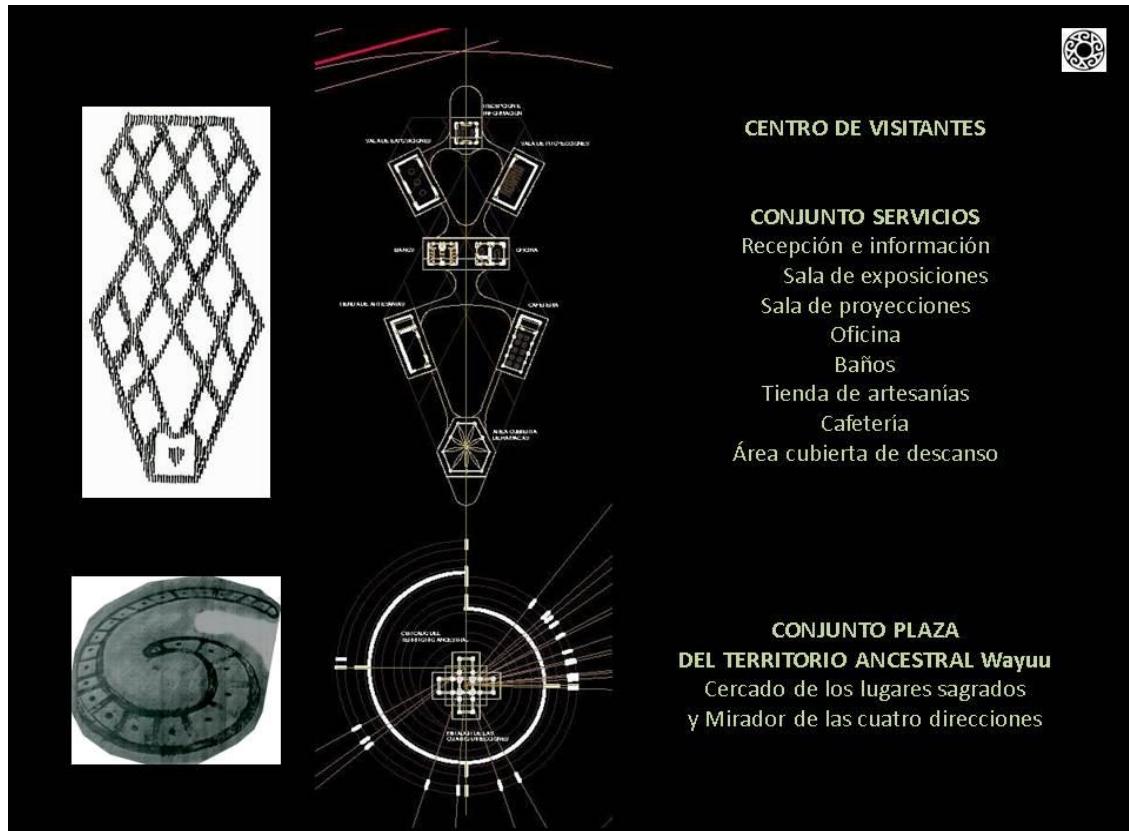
VISTA EN PLANTA DEL CENTRO DE VISITANTES
